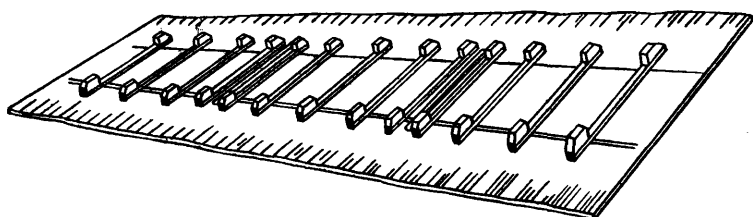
Боек с ваймами для сборки гвоздевых балок с перекрестной стенкой.
